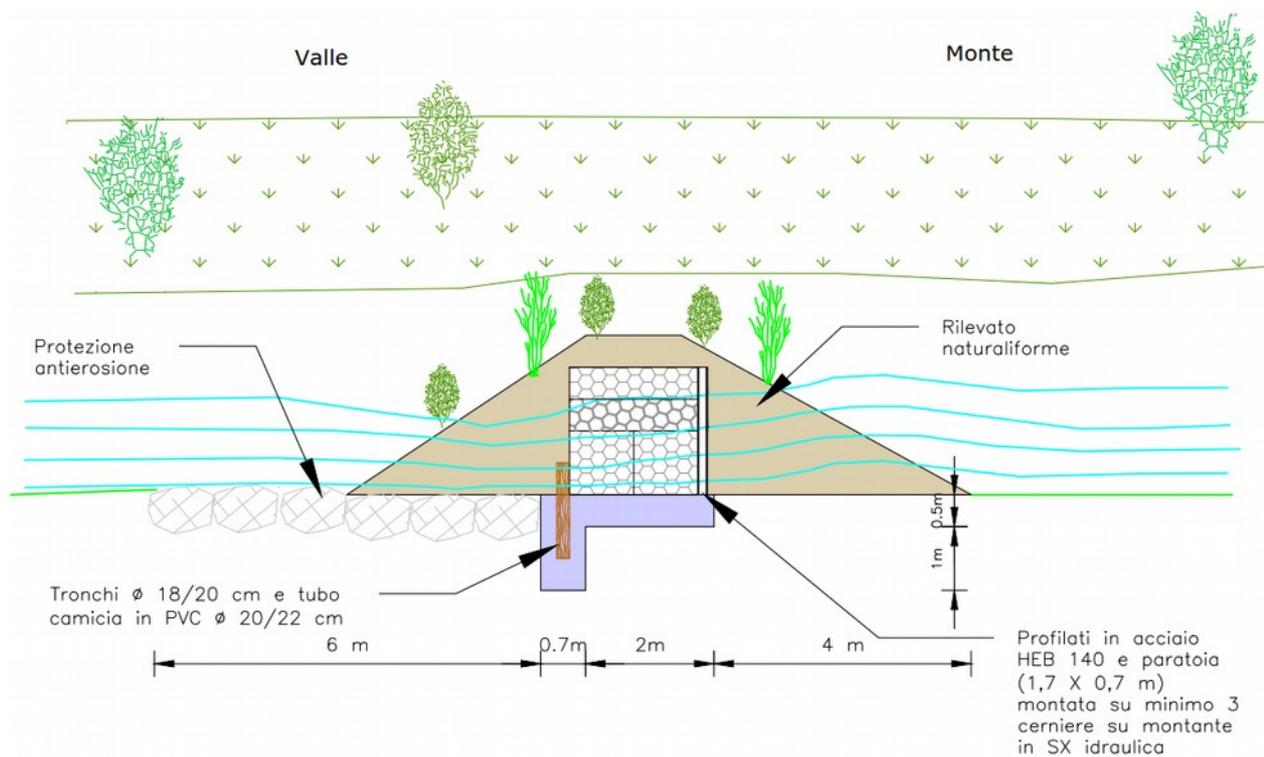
Sezione longitudinale del restringimento di sezione a bocca tarata con anima in pietra.
